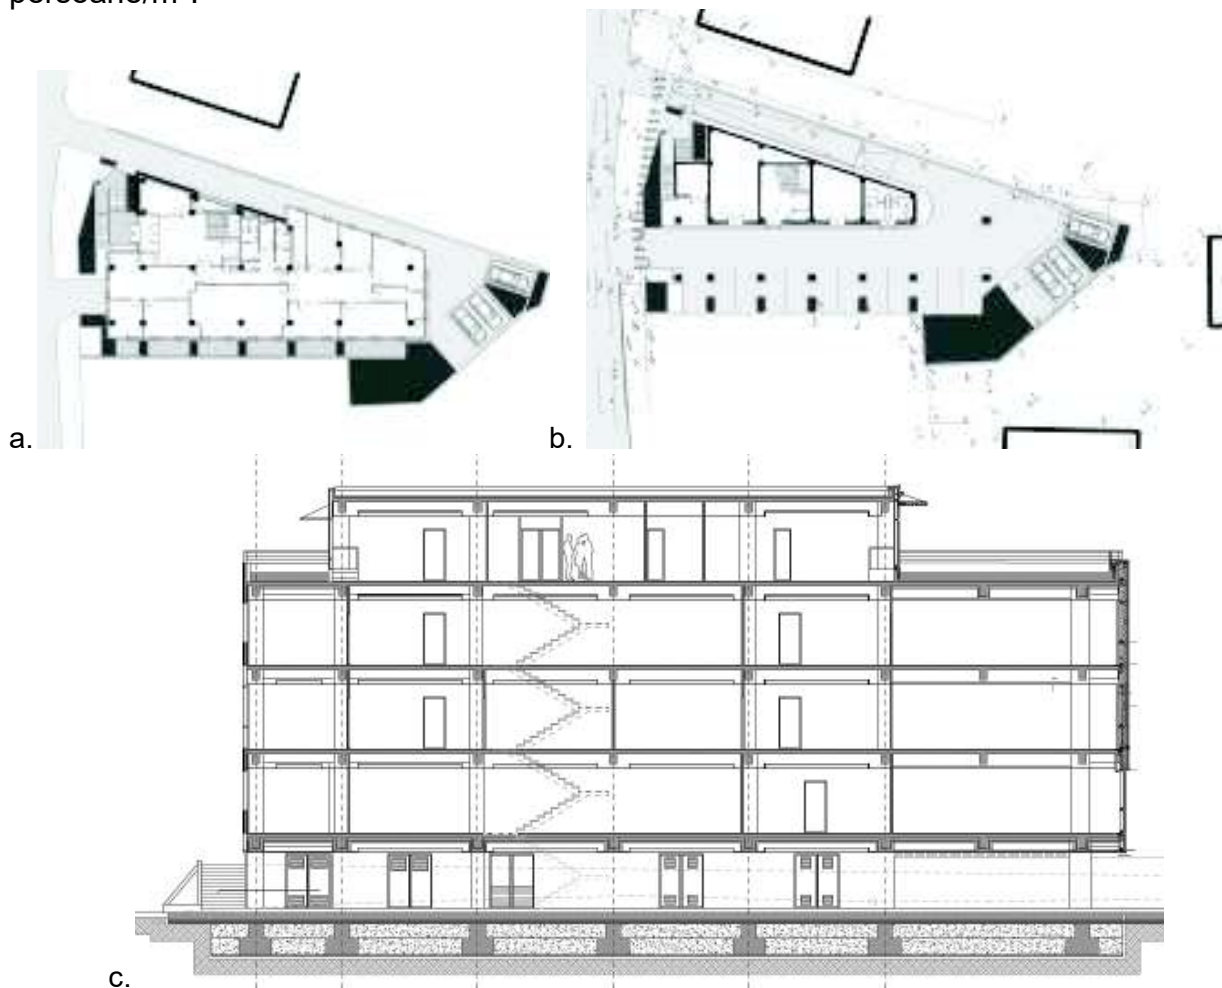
a. plan parter; b. plan demisol; c. secțiune longitudinală [107]
